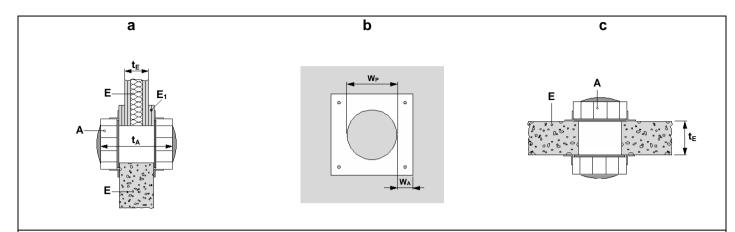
cadre d'ouverture (a, b) et positionnement du calfeutrement de traversée dans les cloisons, voiles et dalles (a, c)
